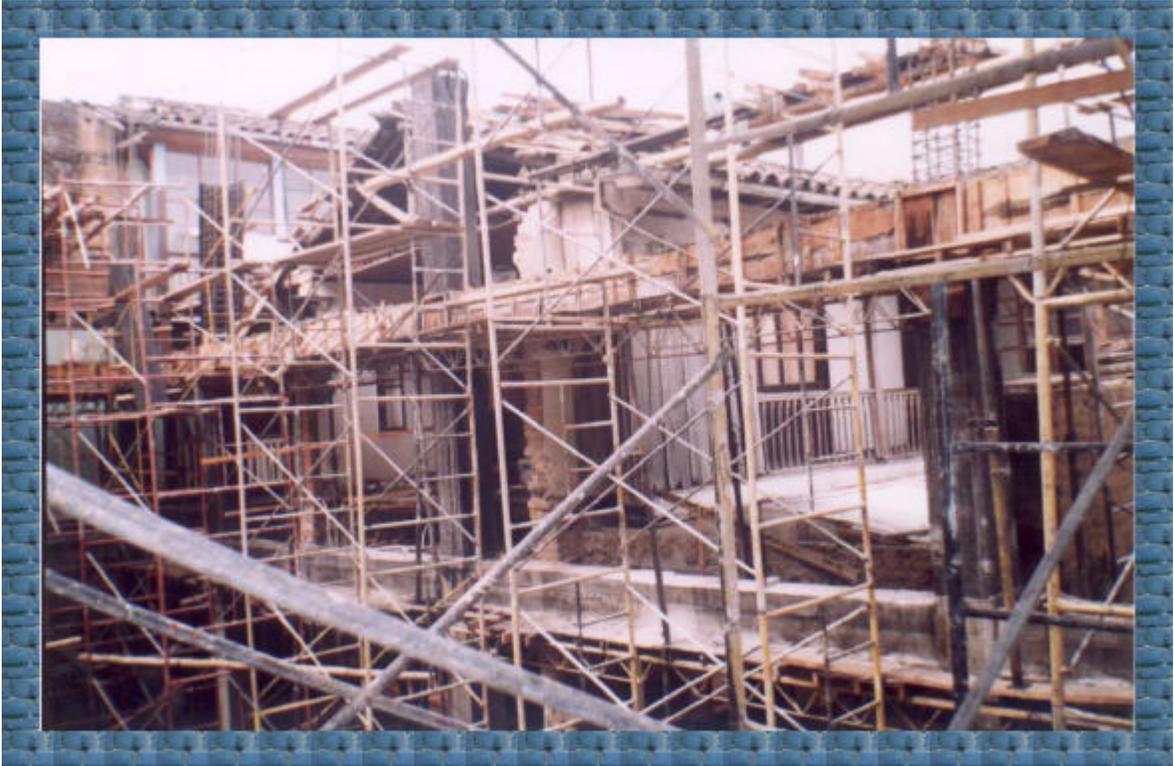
Encofrado de la cuarta viga a una altura de 11.06m
